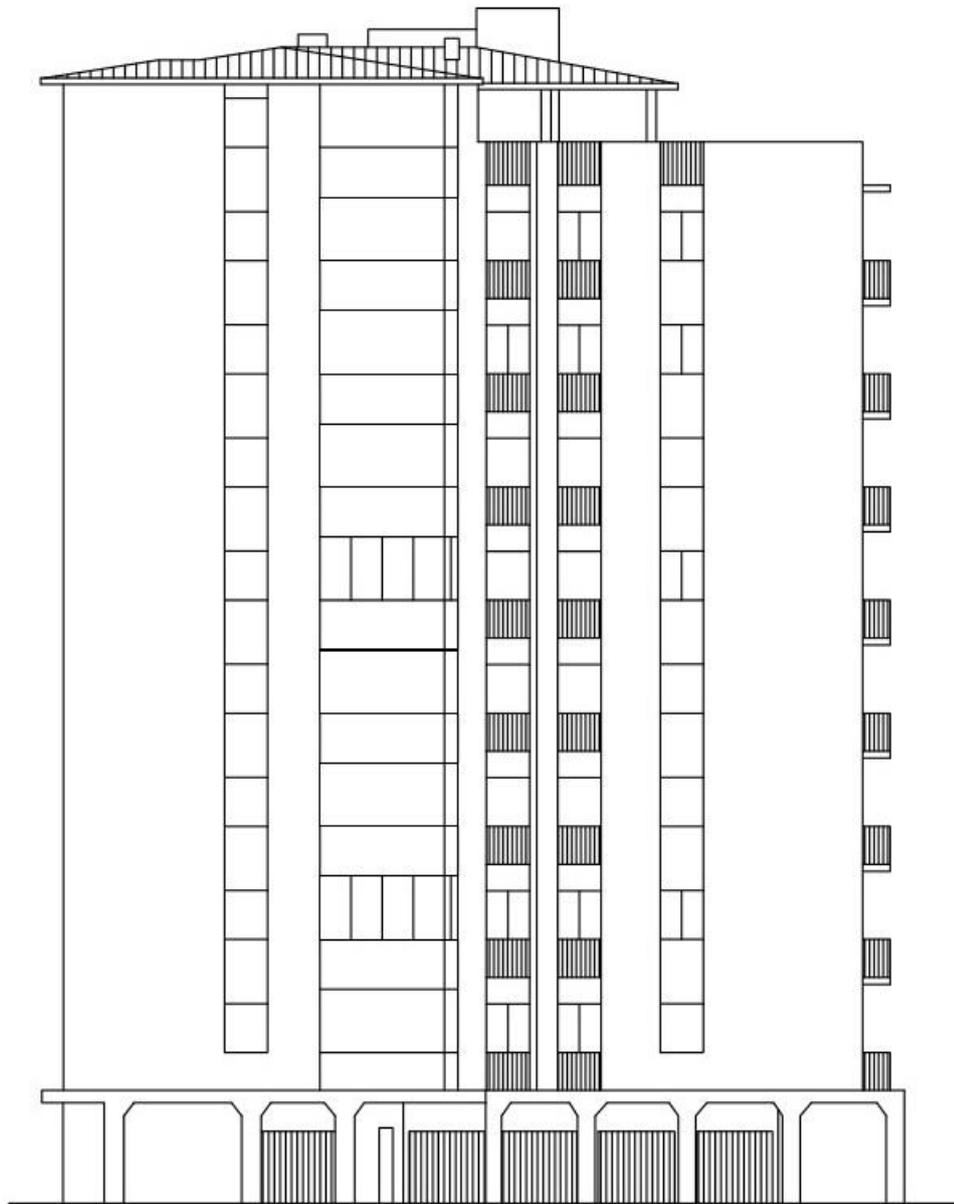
Prospetto Sud, via Brofferio1. Scala 1:200. Fonte: Ater Padova.
